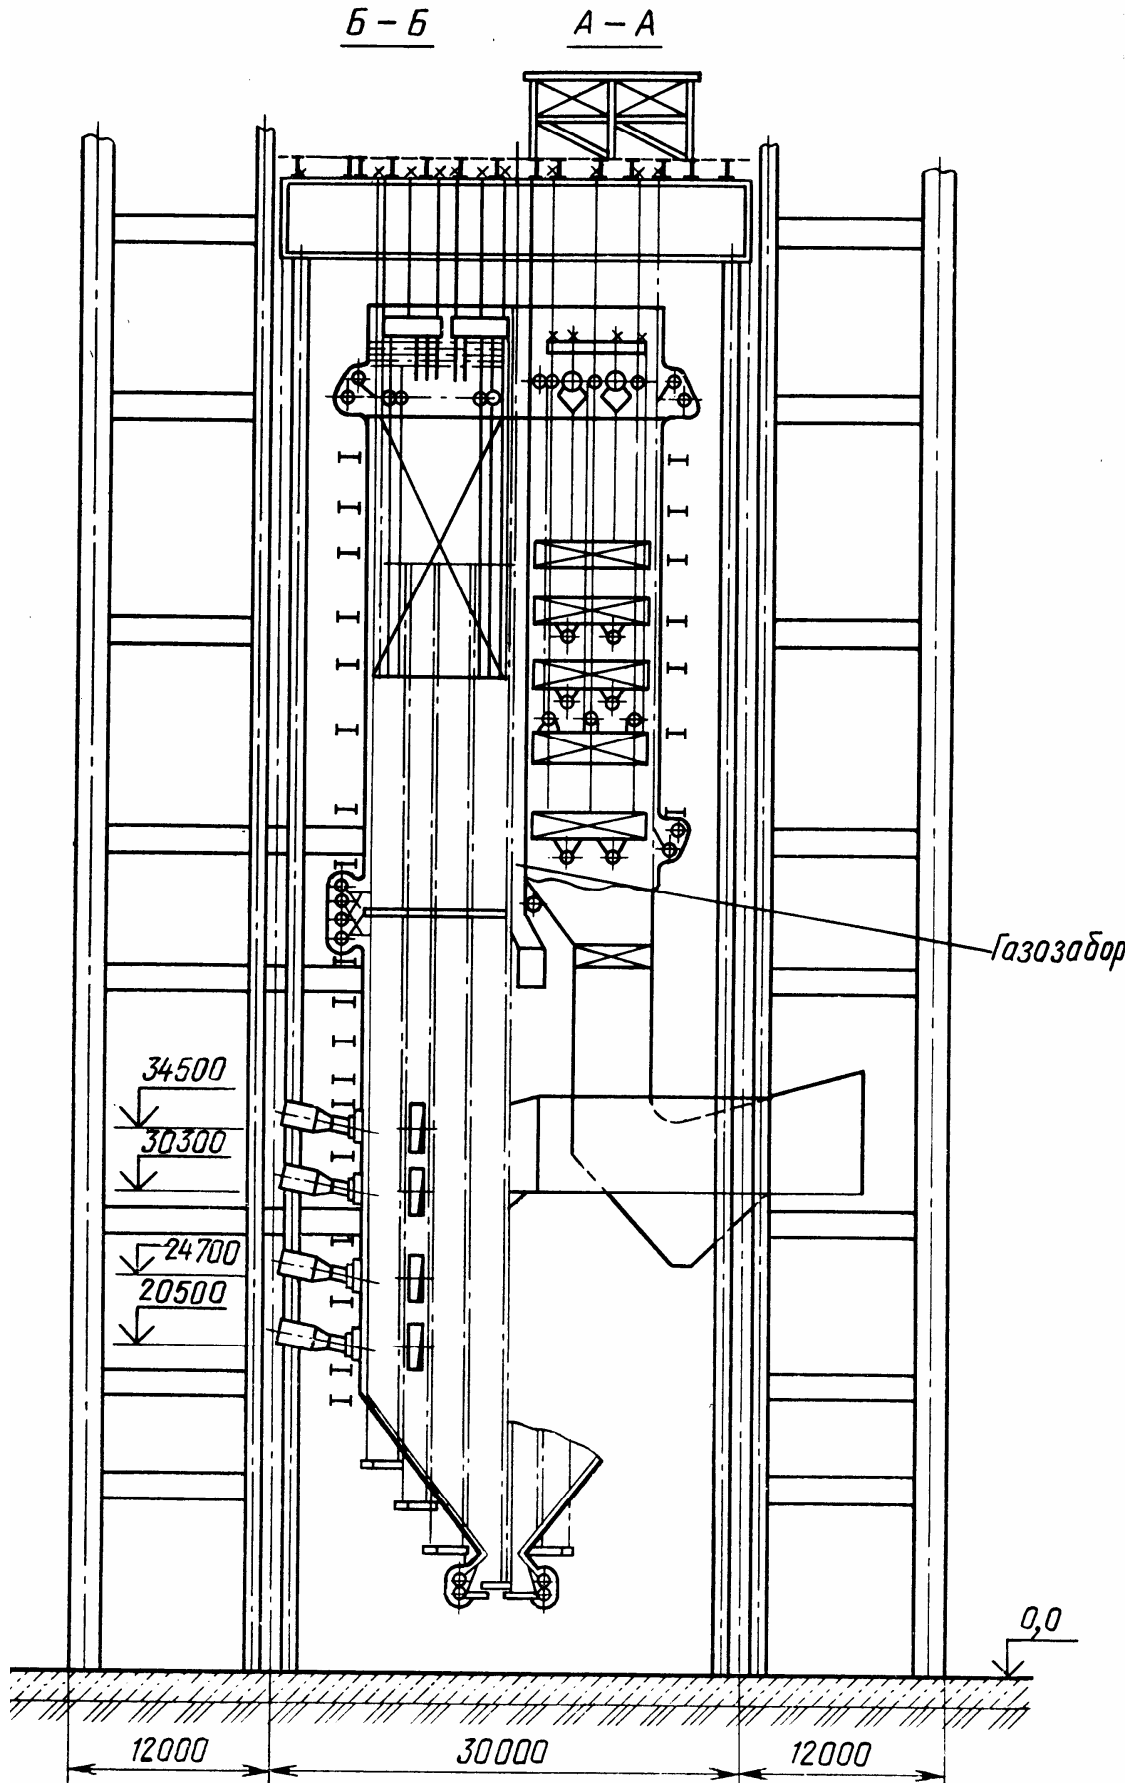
Поперечный разрез котла Пп-1650-25-545 БТ (П-78)
